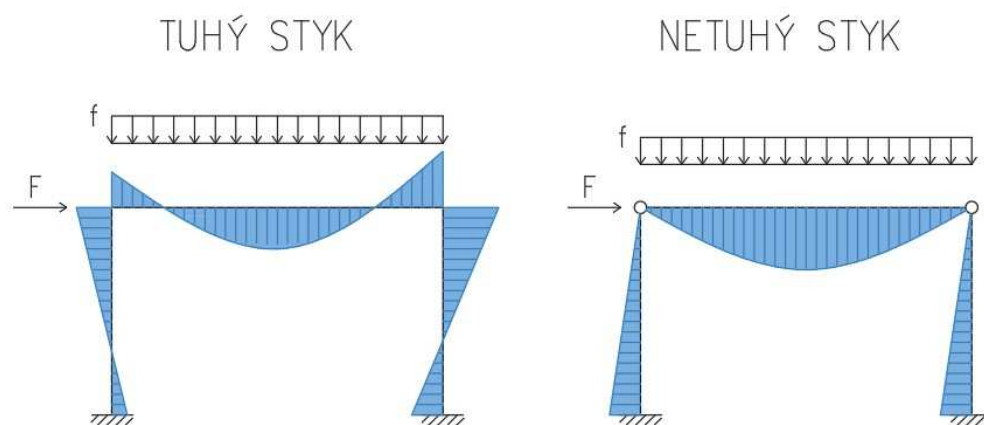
Přehled konstrukčních systémů halových staveb, dle [2]
